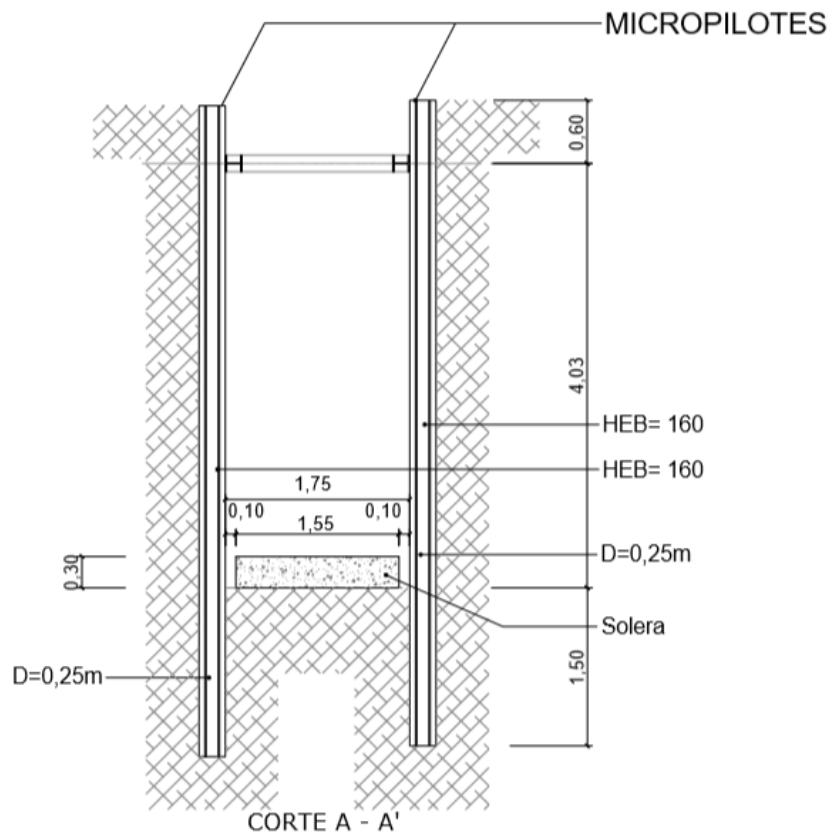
D4-Sección vaciado de solera sección de tramo P4-P5
